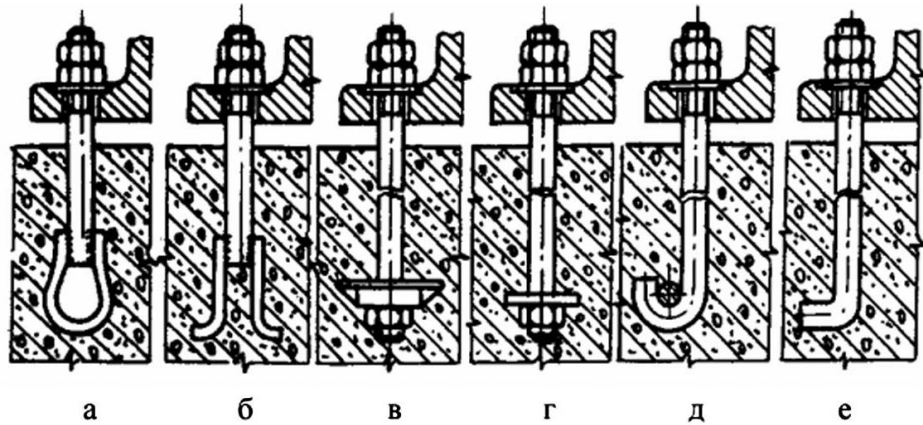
Глухі фундаментні болти які встановлюють до бетонування фундаменту
